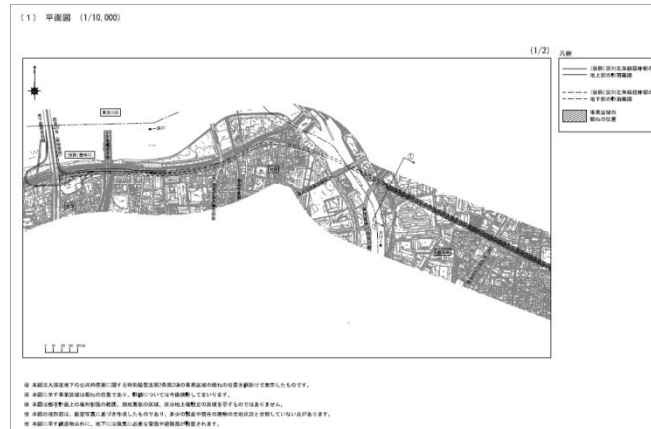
（仮称）淀川左岸線延伸部事業 平面図の一部
